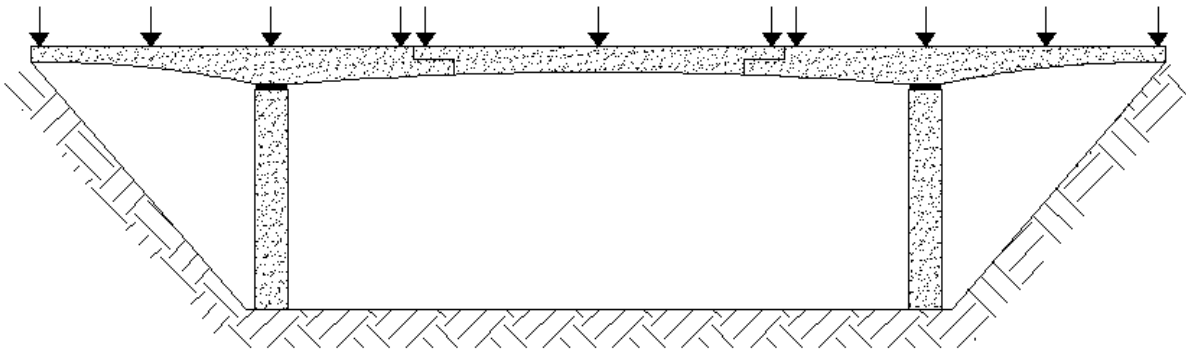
PLACEMENT DES REPÈRES SUR UN TABLIER CANTILEVER
